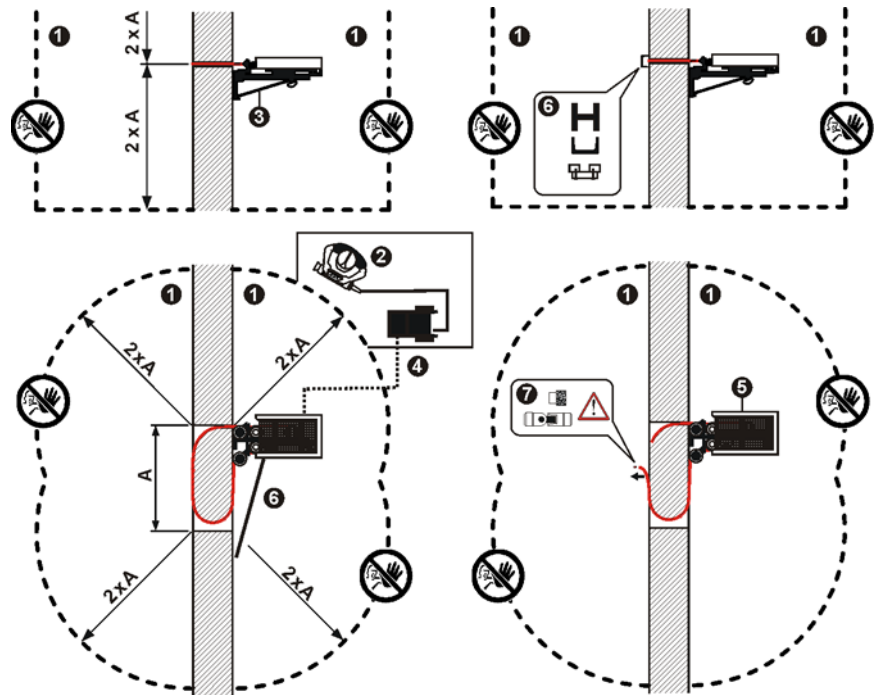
Zona de peligro y trabajo en montaje directo de la cortadora de hilo de diamante
